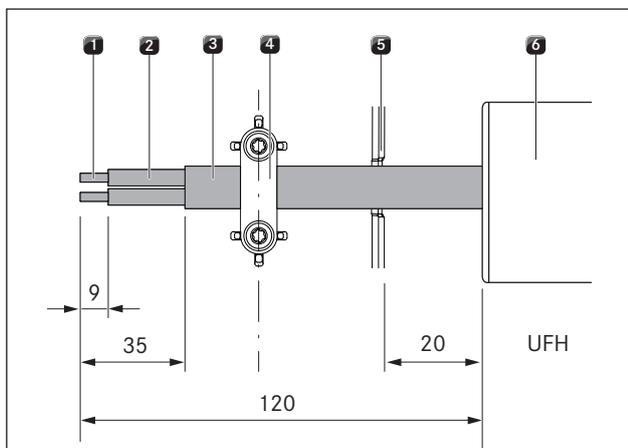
Longitudes de desaislamiento y posición de montaje del cable de conexión de la unidad de control universal
